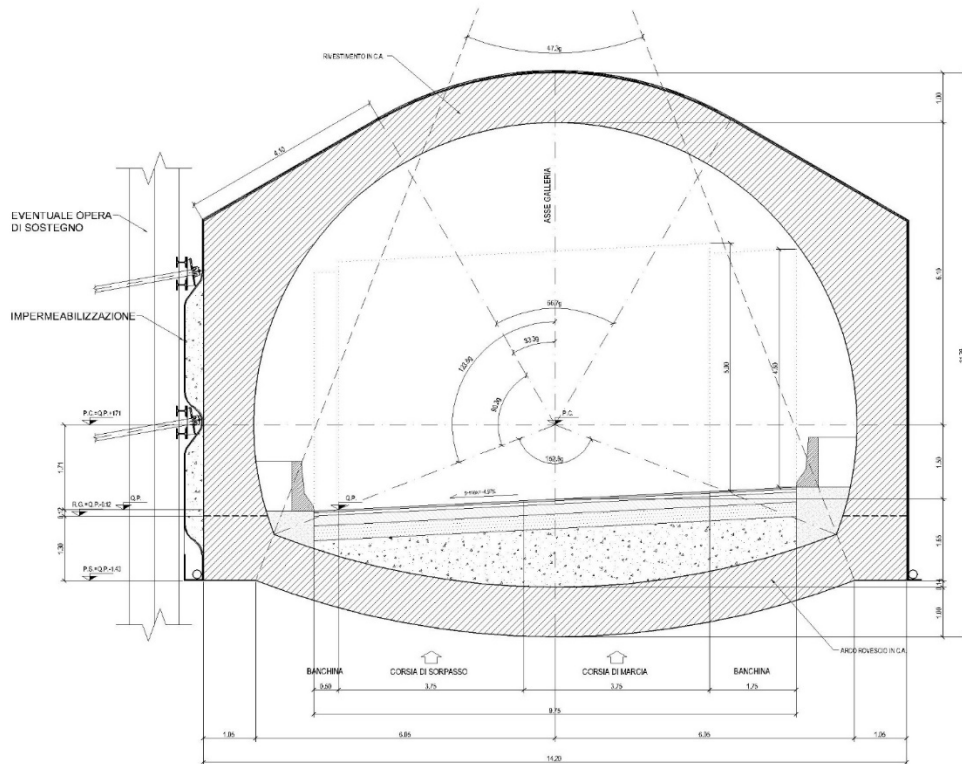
Sezione tipo corrente della galleria artificiale.
